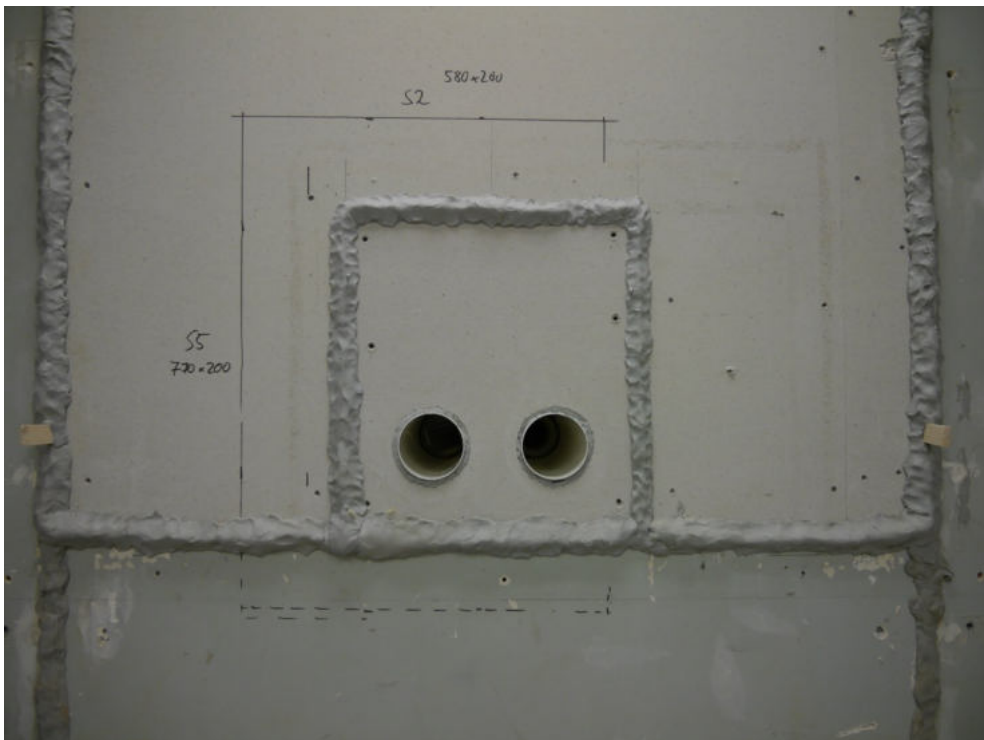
Lüftungsöffnungen außenseitig (Fortluft links, Außenluft rechts), Fassadenabschluss Edelstahlschote noch nicht montiert.
